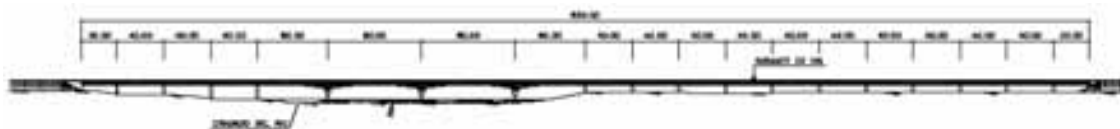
Viaducto sobre el Guadalquivir. Alzado.
